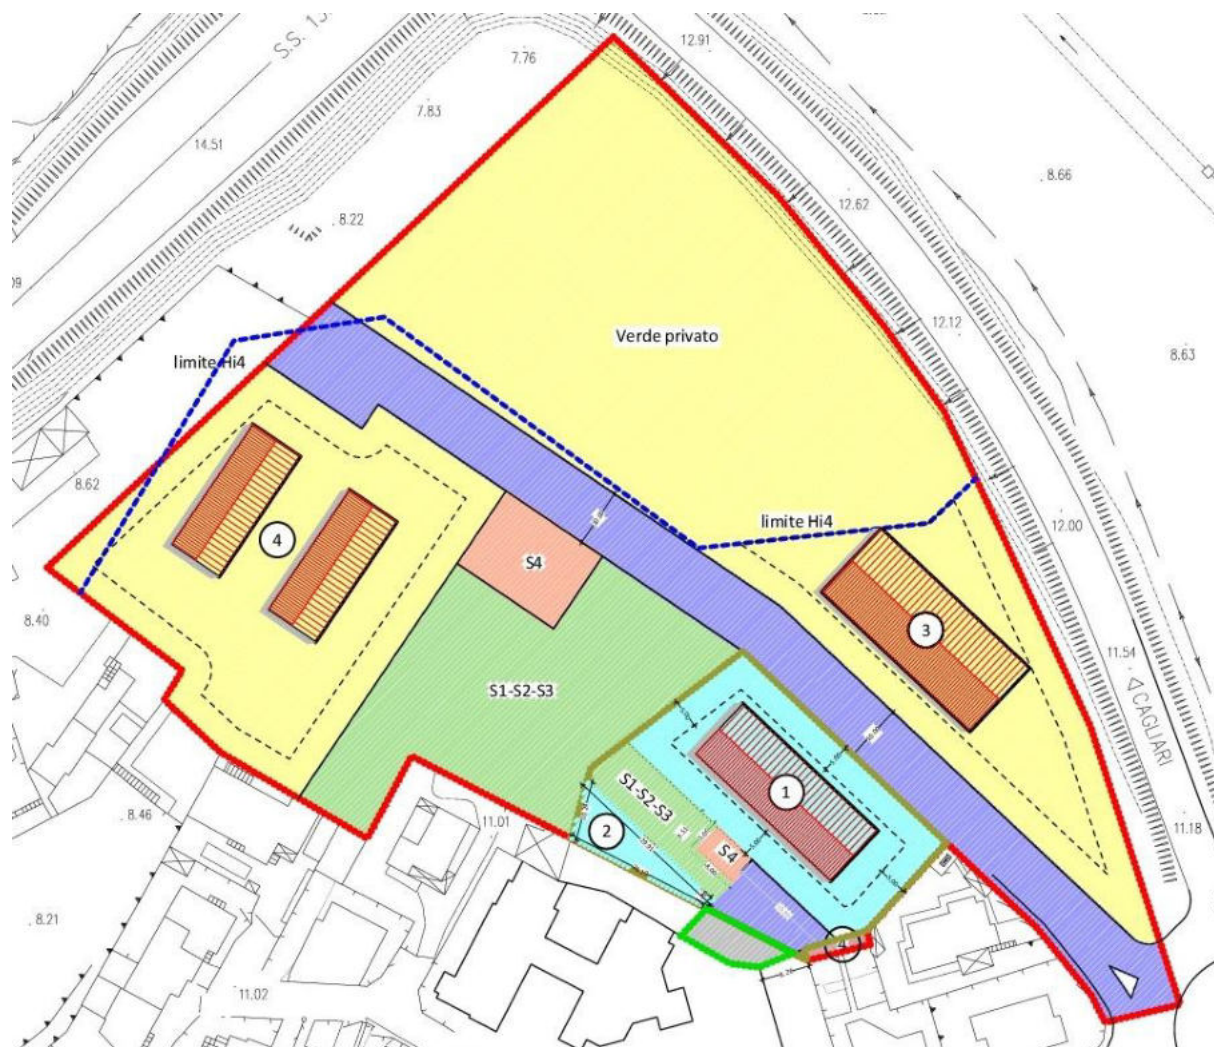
planimetria del comparto oggetto di pianificazione - destinazione in progetto delle superfici
